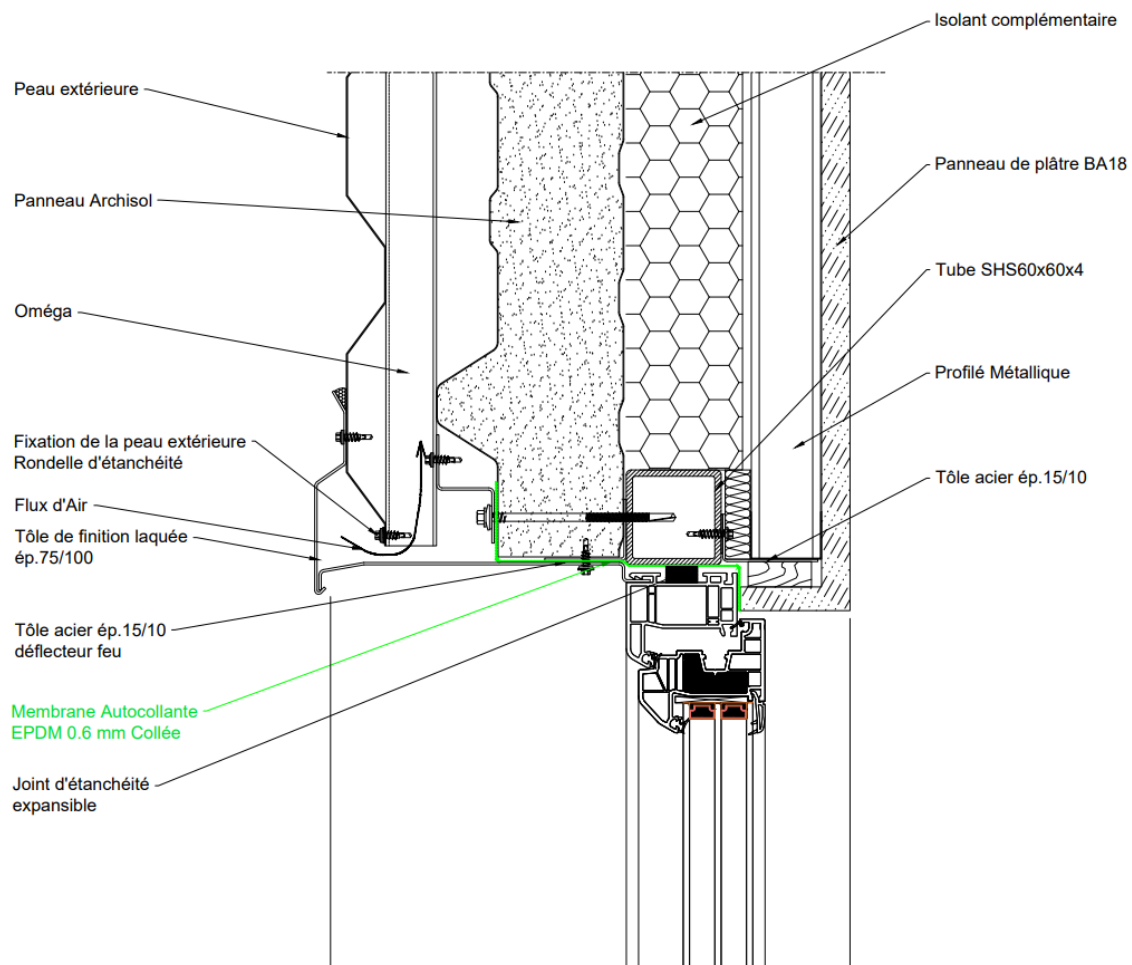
Coupe verticale sur la jonction linteau – D2B Archisol - Ossature en simple réseau
